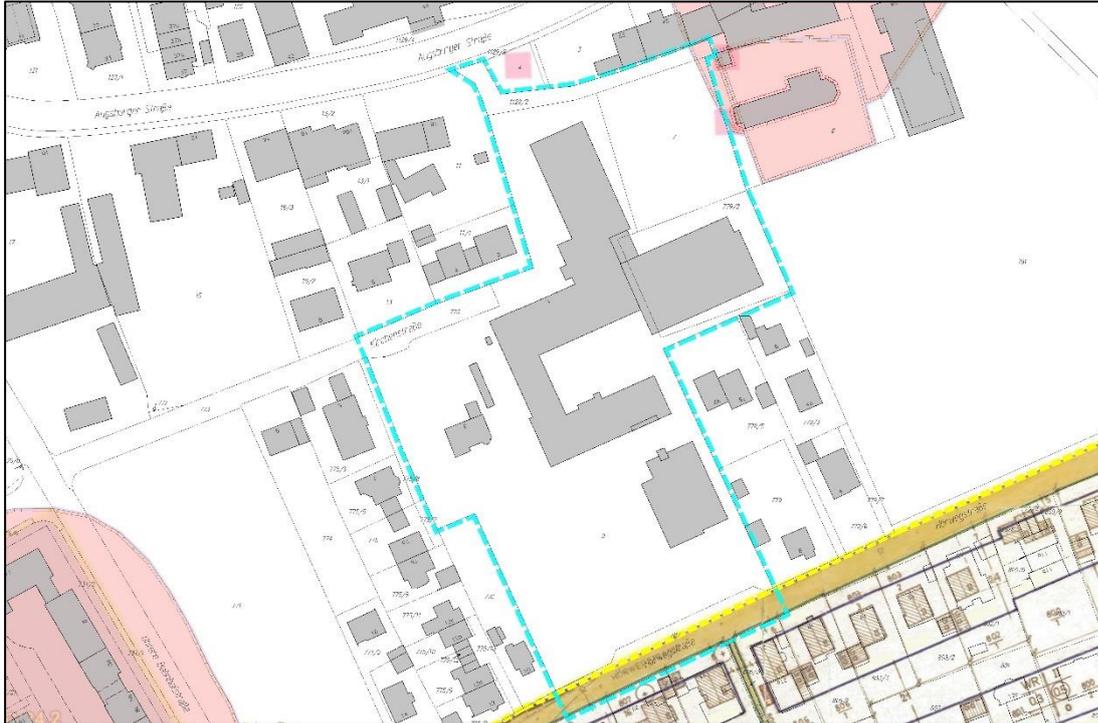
Geltungsbereich (cyan) Rechtsverbindlicher Bebauungsplan „IG 22“ (gelb) und kartierte Bau- und Bodendenkmäler, Plangrundlage © LVG-Bayern (Originalmaßstab 1/2.000)
